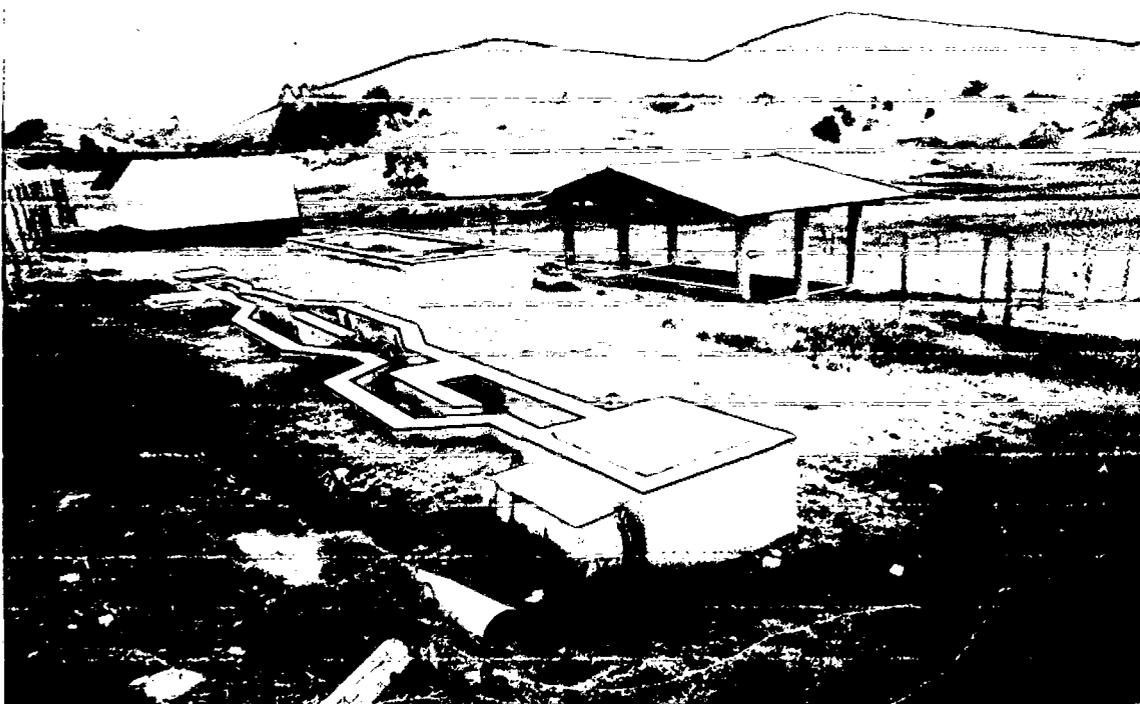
, 17 y 18 verificando que todas las viviendas cuentan con los servicios de alcantarillado.
